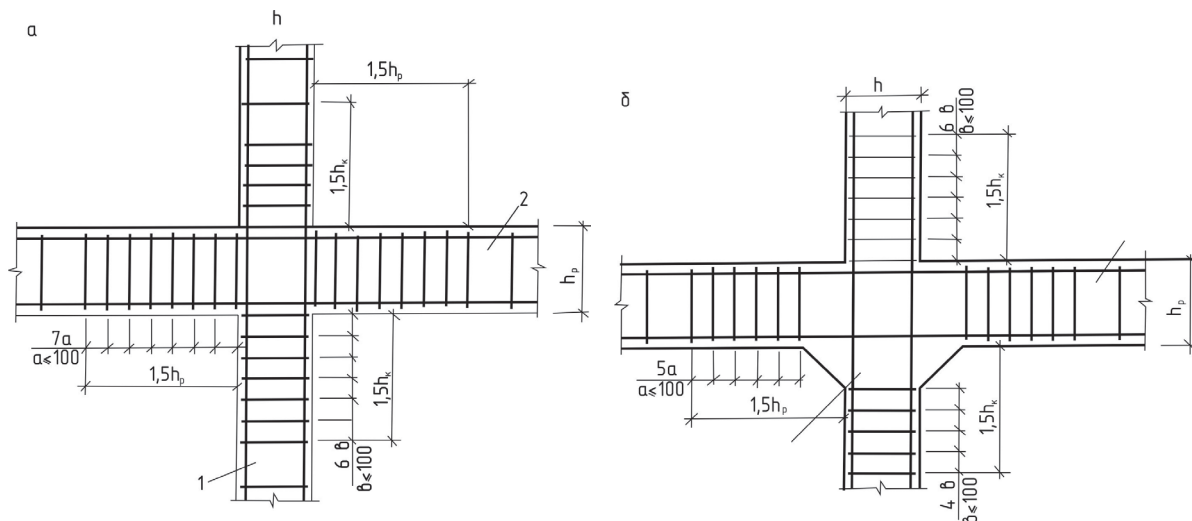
Армирование поперечной арматуры участков колонн и ригелей, примыкающих к узлу
